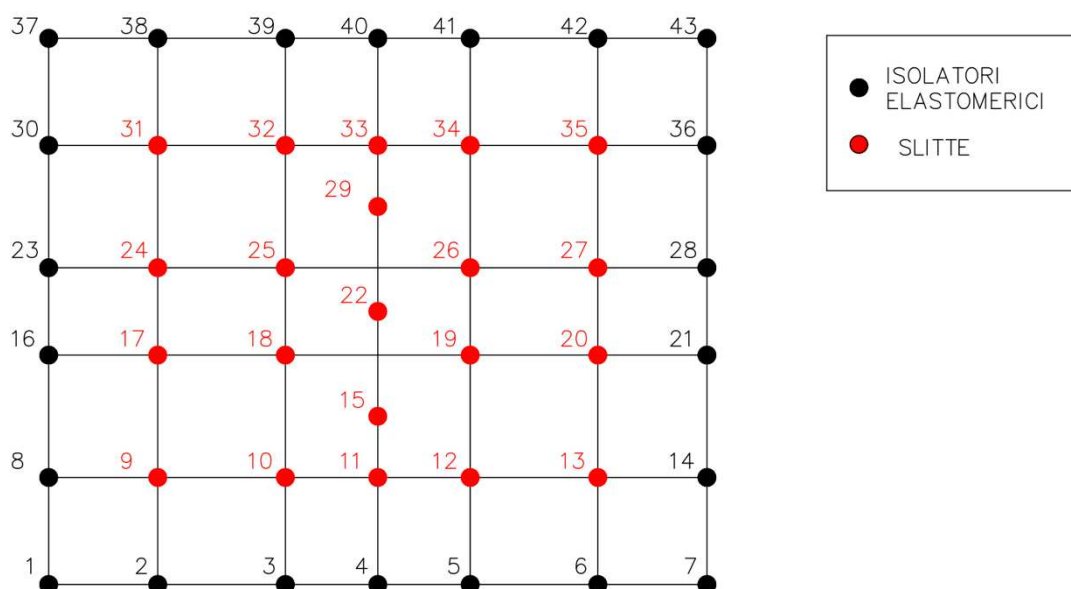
Disposizione in pianta degli isolatori elastomerici e delle slitte.
